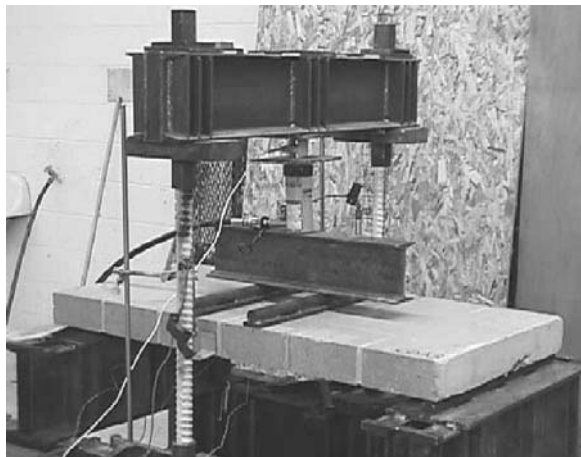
44 — Configuración de ensayo de paneles sujetos a carga de flexión (Tumialan et al., 2002).
